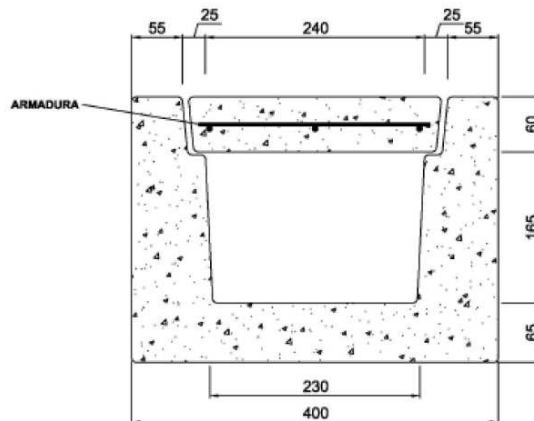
Geometría de canaleta (Fuente:ADIF)
